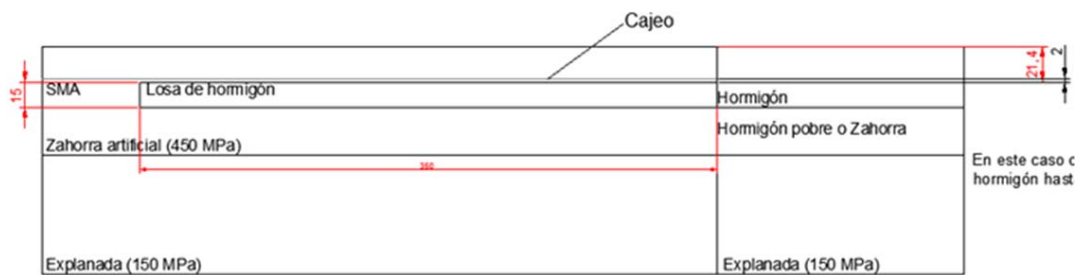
Transición entre vía en placa de hormigón y vía en placa bituminosa. Fuente: elaboración propia.
